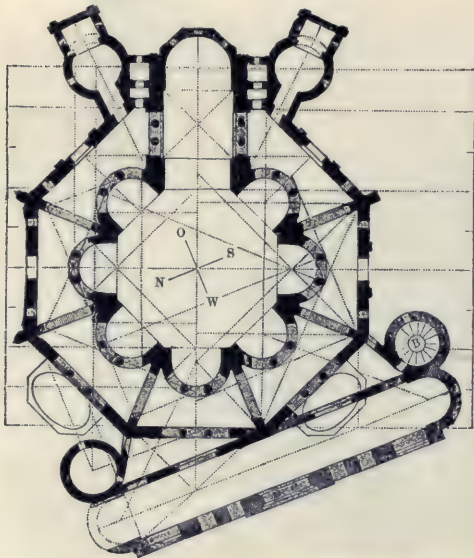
S. Vitale zu Ravenna. Grundriss.
